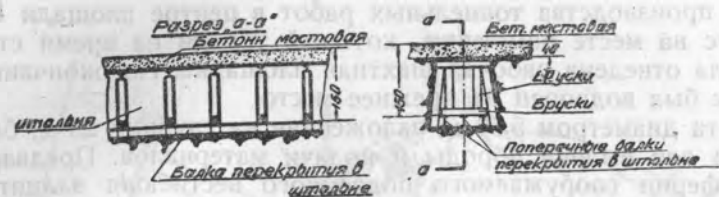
Проходка штольной под мостовой для закладки металлических балок несущего перекрытия.
